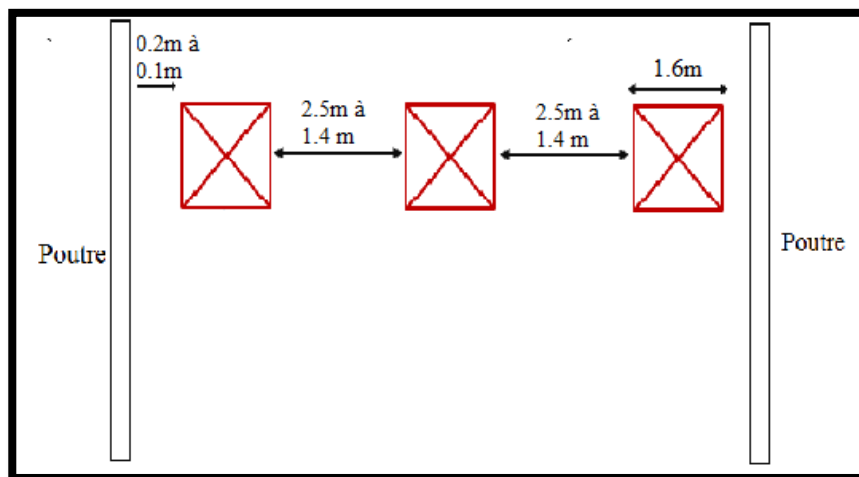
EXEMPLE POUR UNE PREDALLE BP DE PORTEE 8.5M
